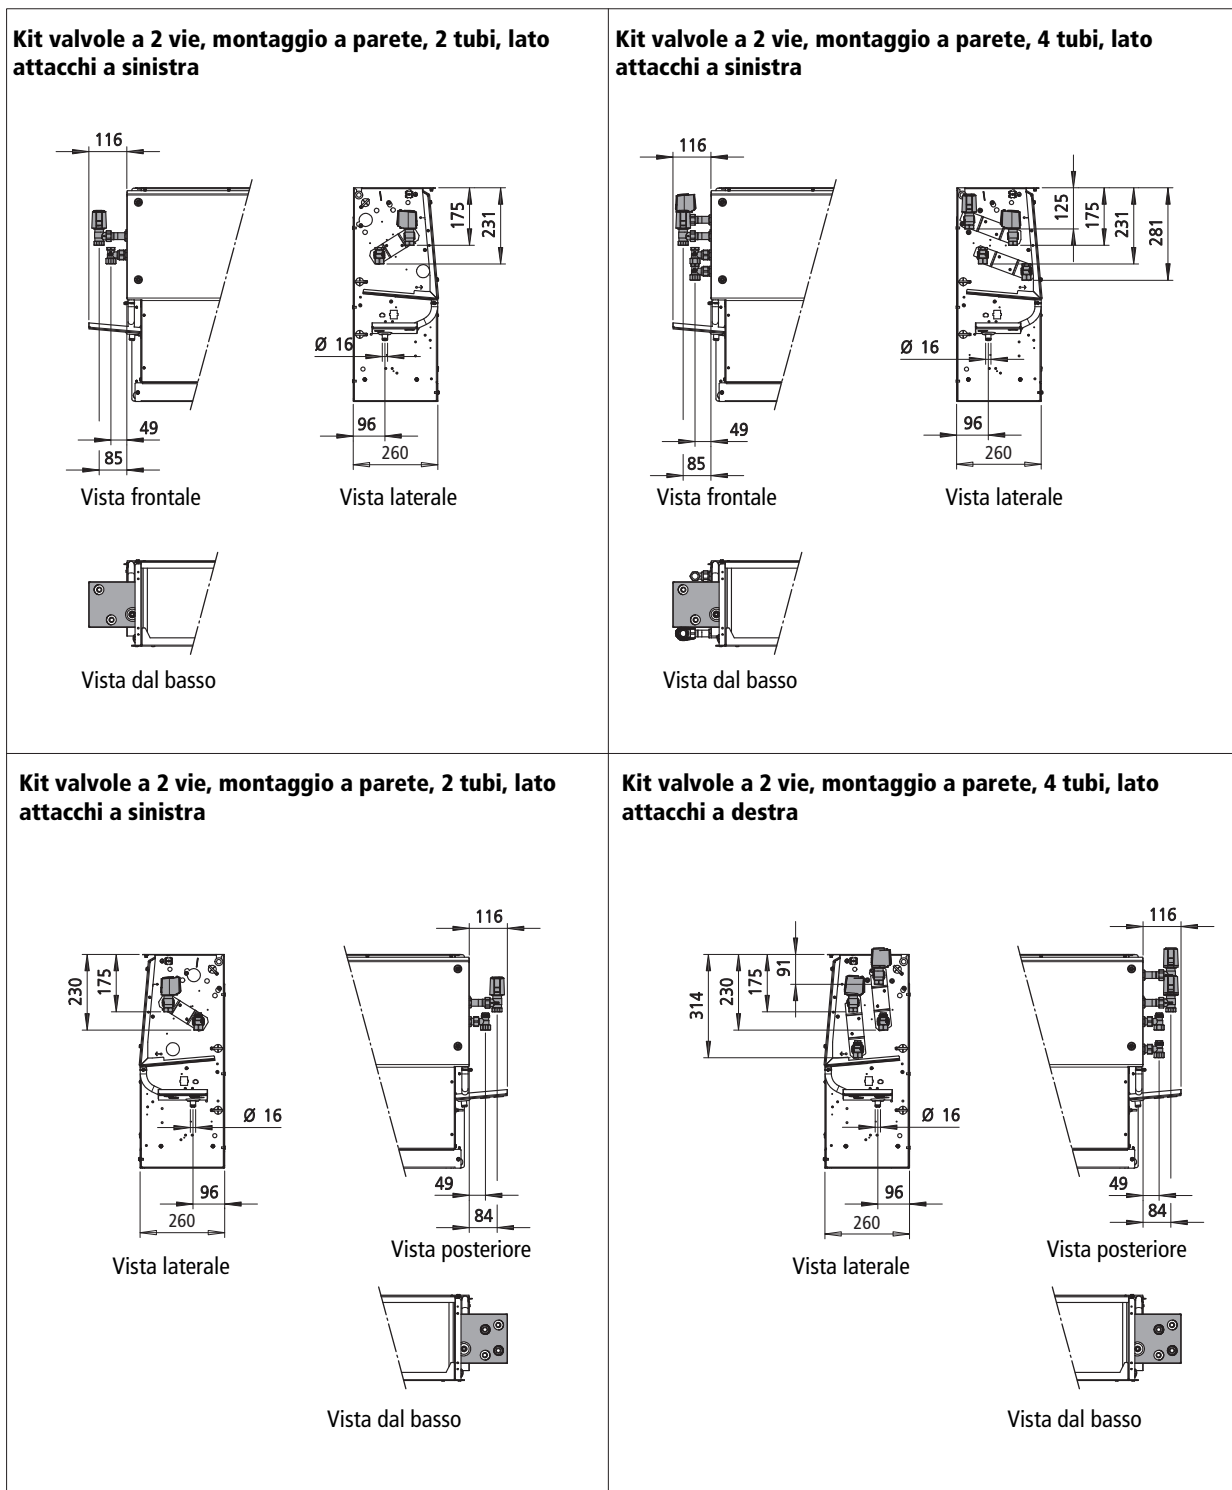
Dimensioni kit valvole a 2 vie (esecuzione a parete)
